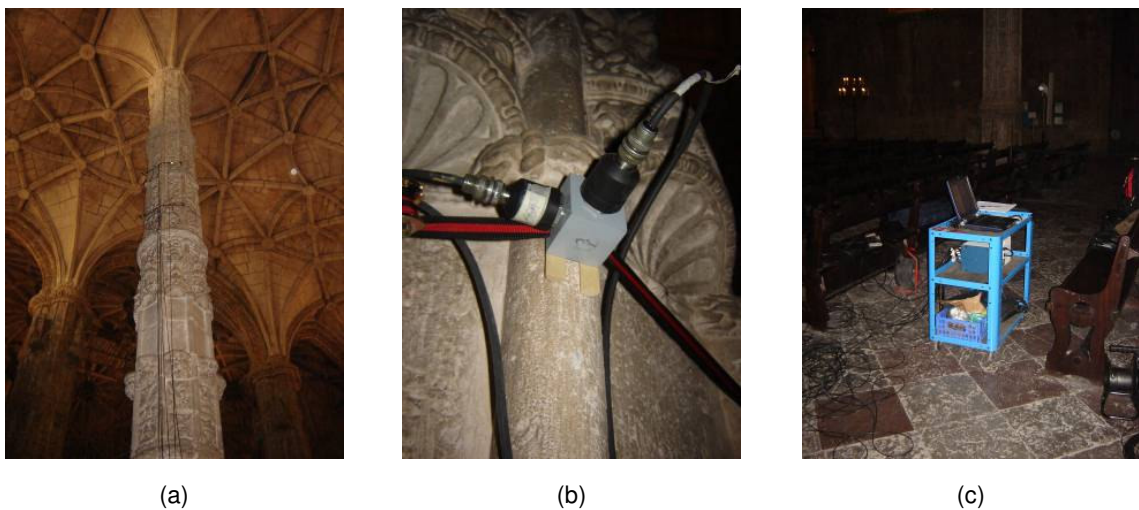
Identificação dinâmica dos pilares da nave: (a) fuste do pilar instrumentado; (b) pormenor da fixação dos acelerómetros; (c) equipamento de aquisição e controlo.
